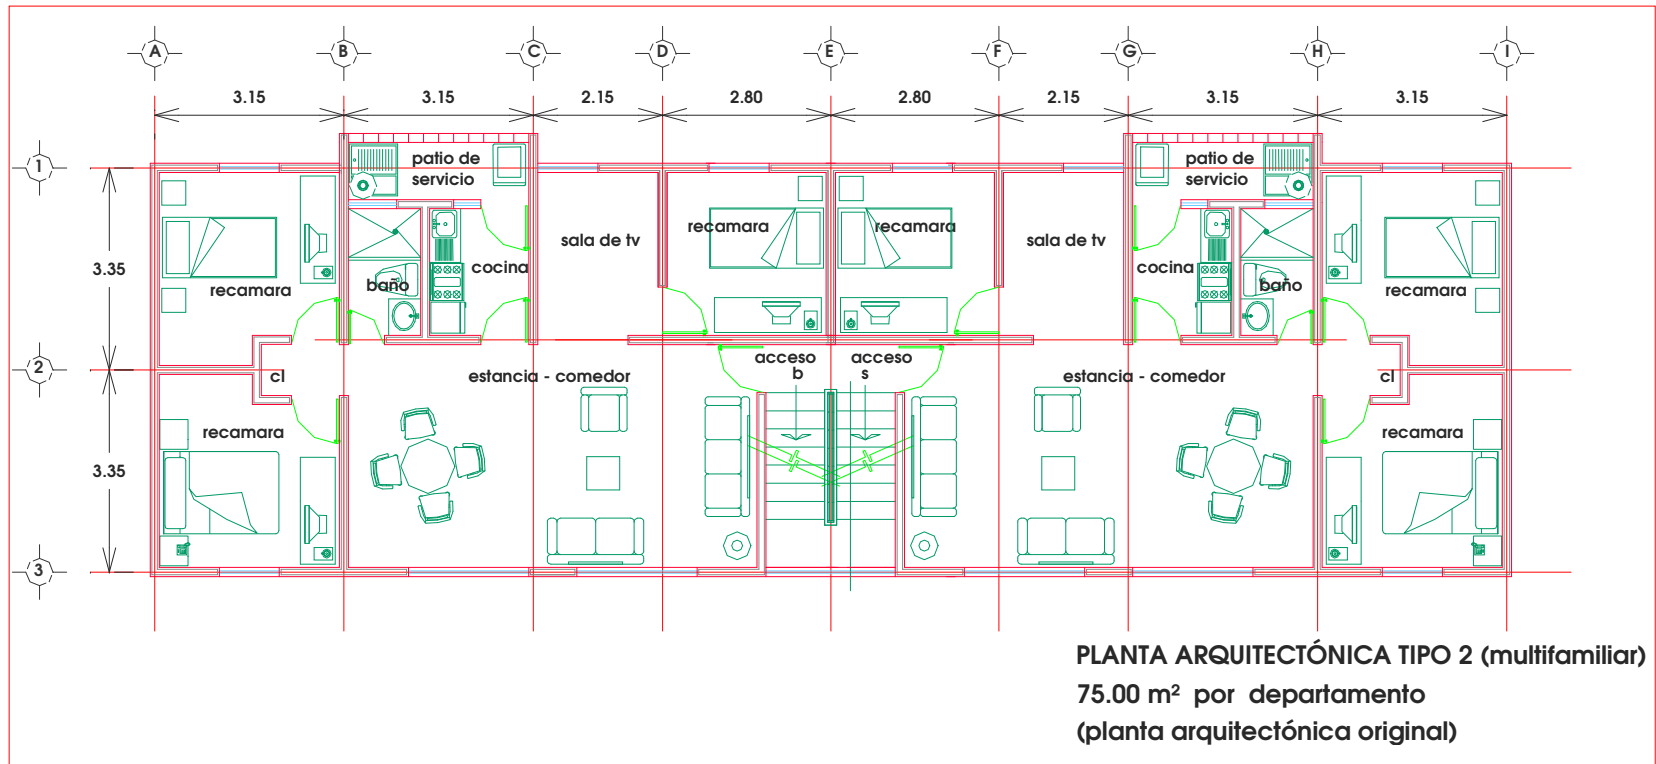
Planta arquitectónica multifamiliar tipo 2
